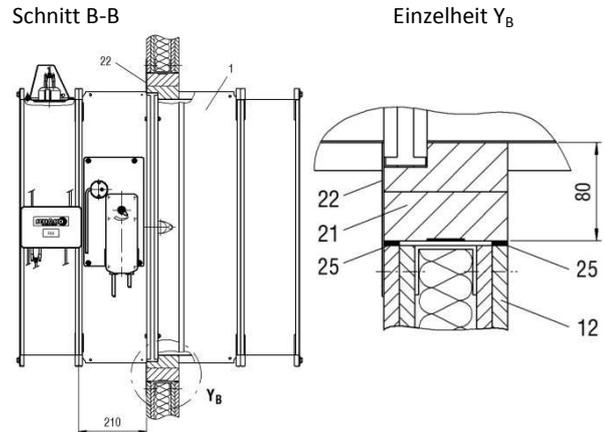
Metallständerwerk mit erforderlichen Auswechslungen für BKA-Ü mit Einbaurahmen ER (Wanddicke = 100 mm)
